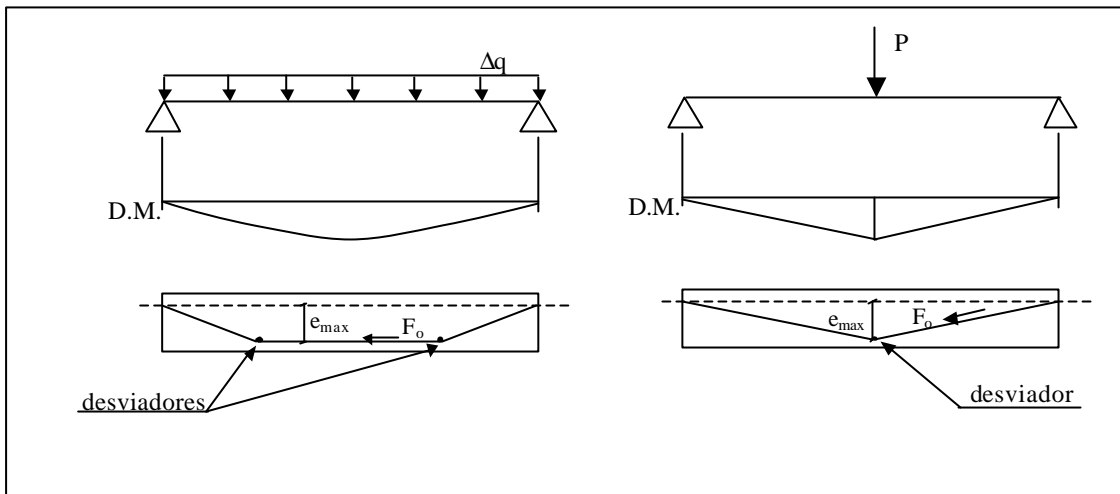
Perfil dos cabos de protensão para duas situações de carregamento utilizando armadura longitudinal externa protendida
